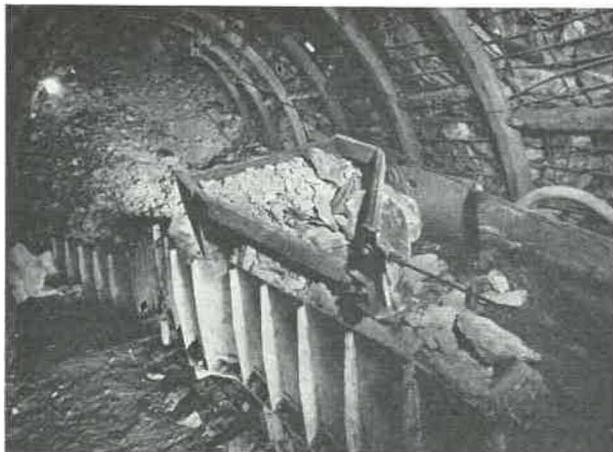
Chargement sur transporteur à courroie par scraper-houe et estacade, dans un bouveau plantant à 14°, en creusement. Le scraper-houe achemine sa charge de terres sur l'estacade vers la trémie de chargement sur le transporteur à courroie.
